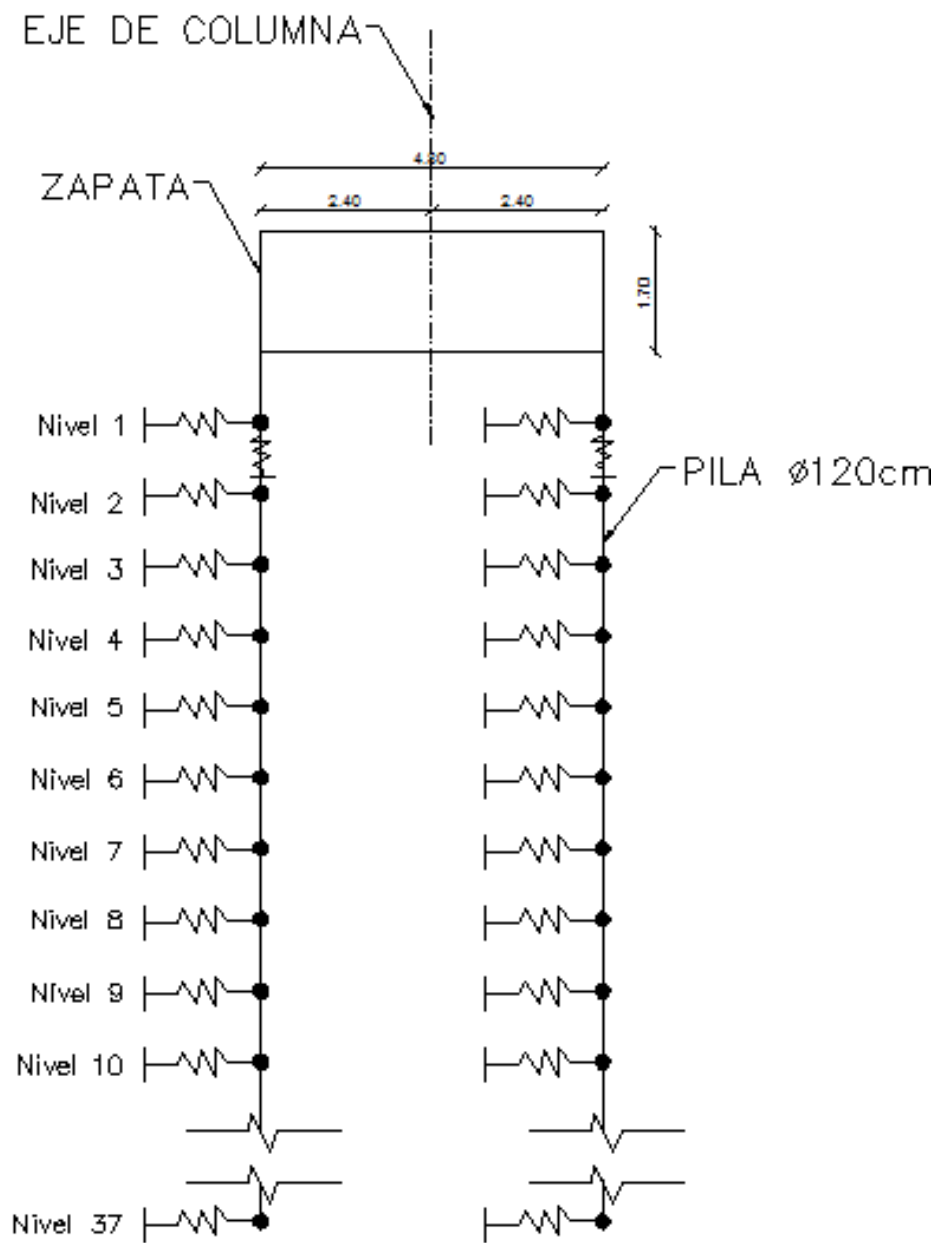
Vista lateral de la ubicación de resortes sobre las pilas
